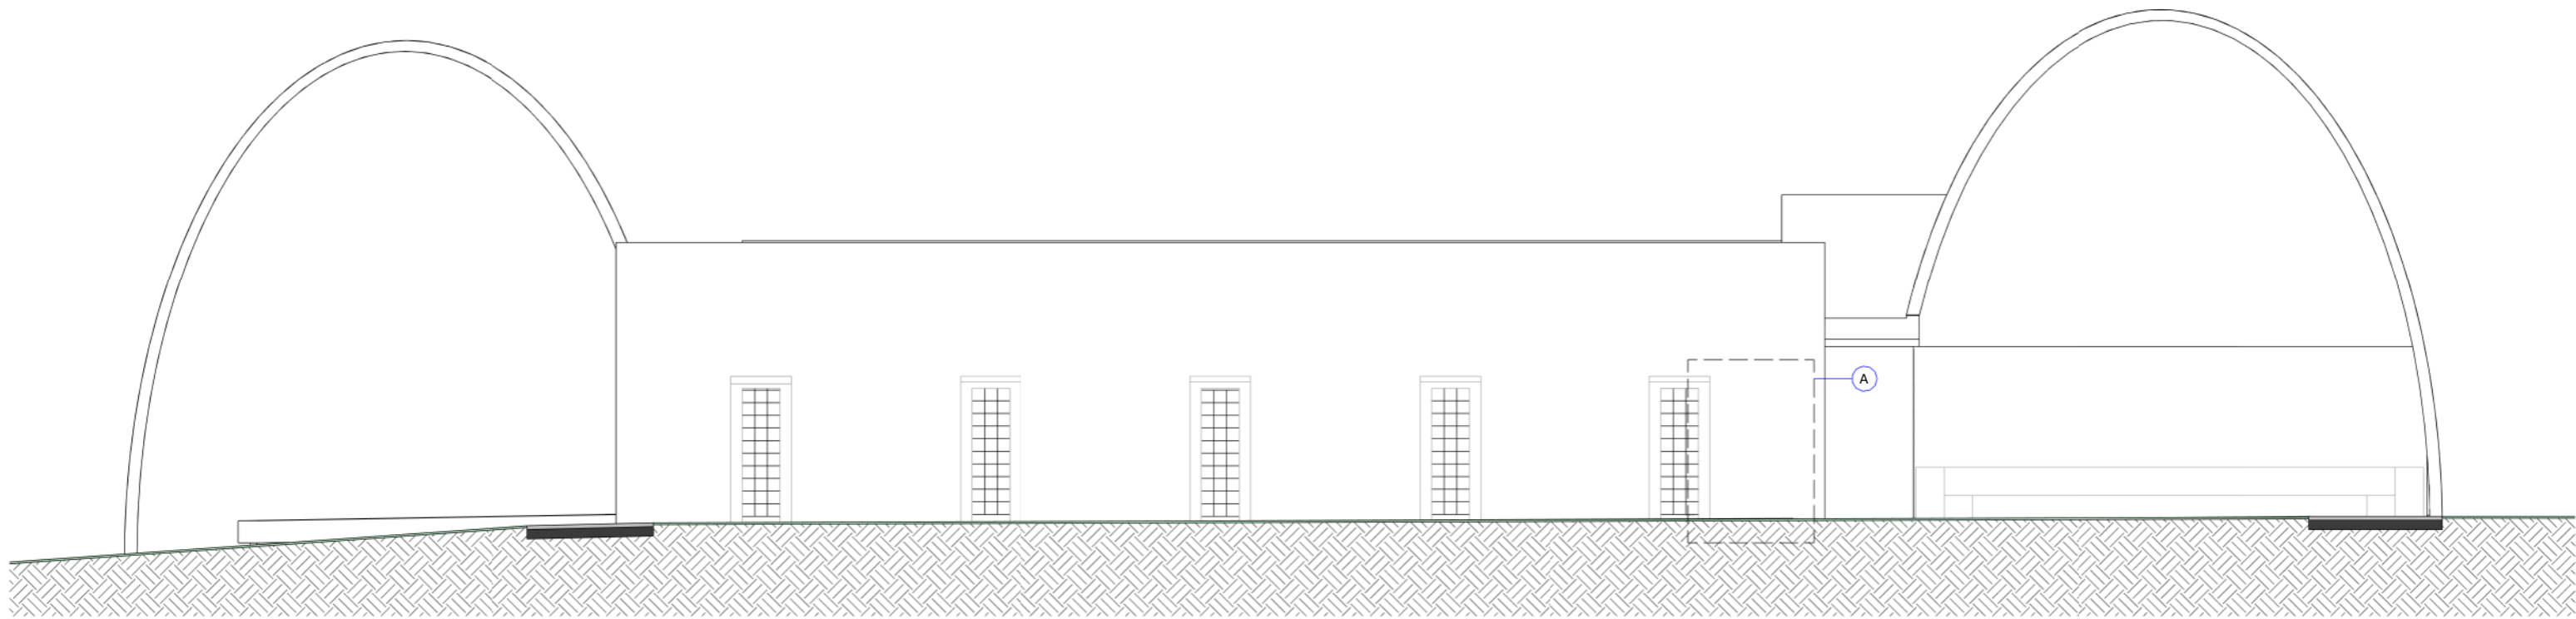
Fachada frontal na escala 1:100. Elaborada por Ana Coêlho.
